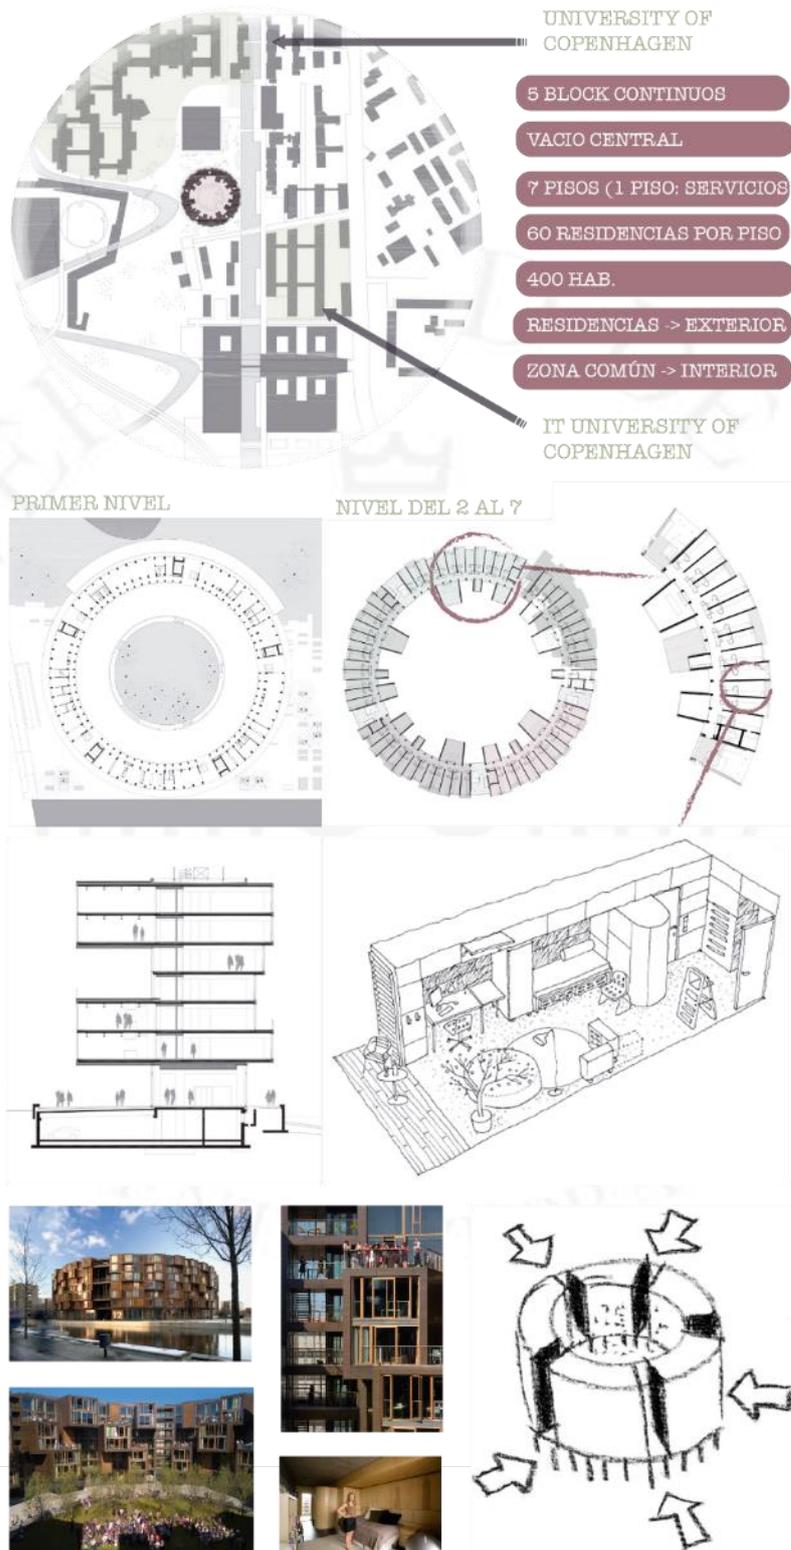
Planta niveles superiores Tietgenkollegiet
